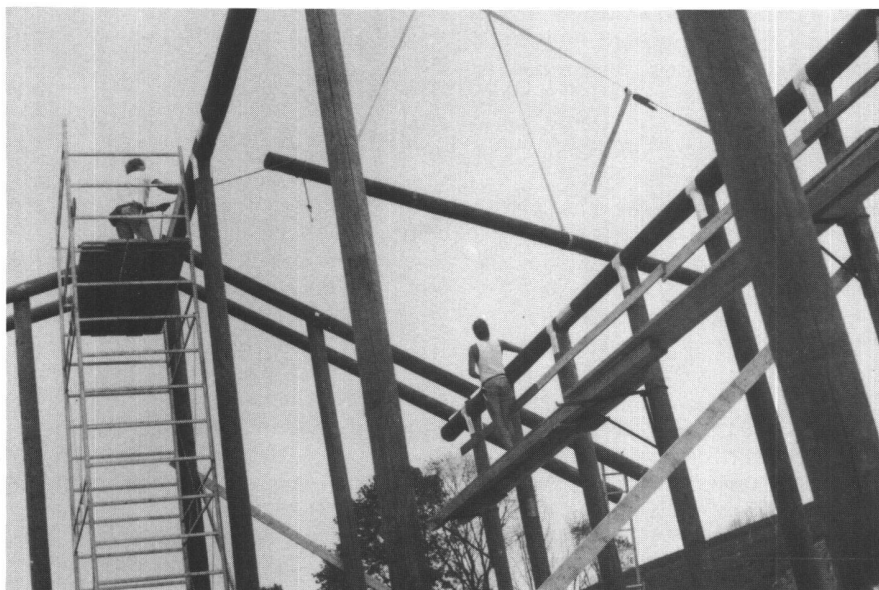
Rundholzbauweise – Ein eigenleistungsfreundliches Bausystem (Foto: Bieri, Überstorf).
